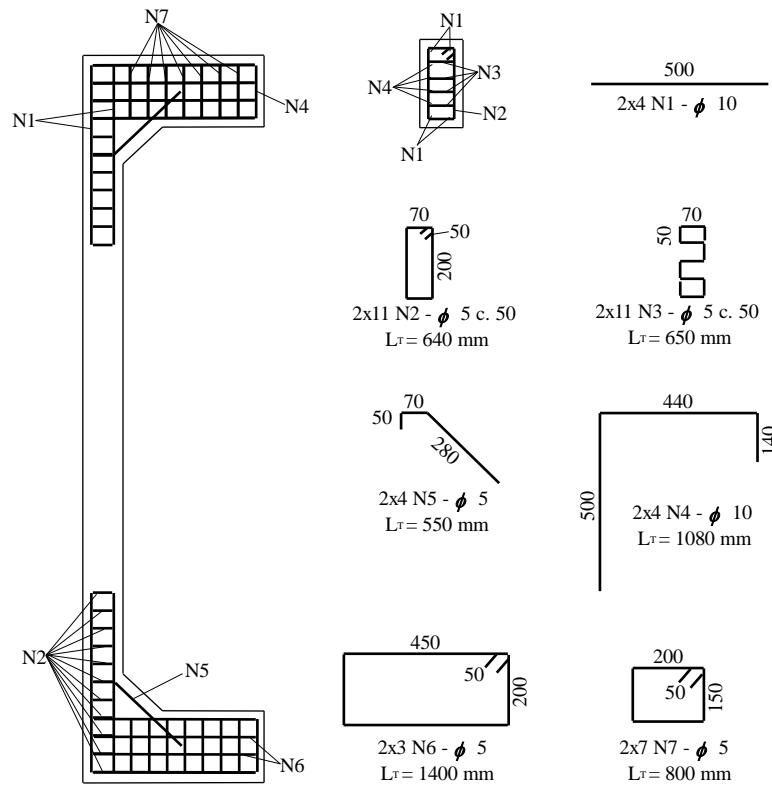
14 - Detalhamento das armaduras dos pilares da série PSA (ADORNO, 2004)
